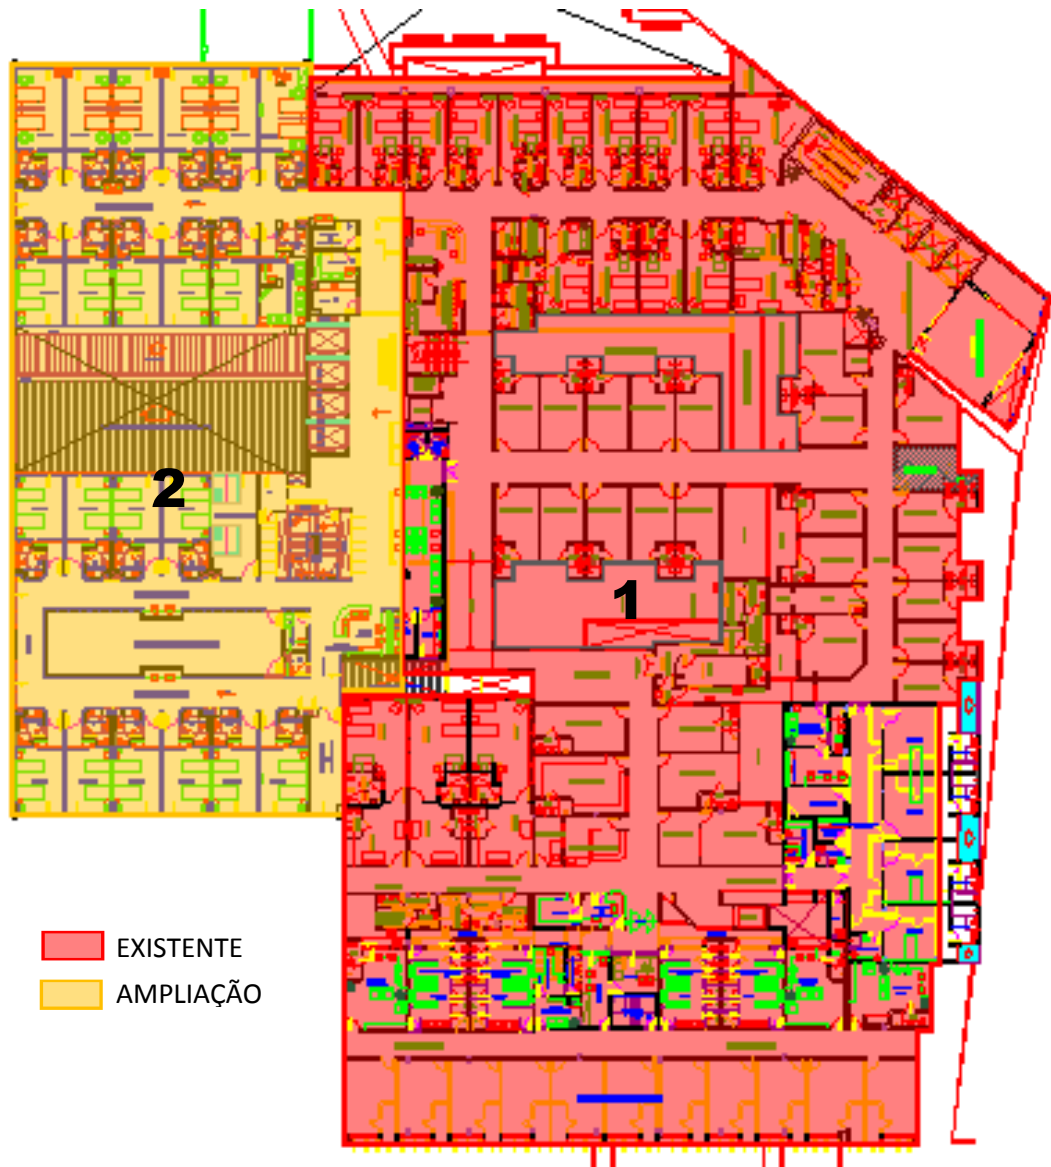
Planta baixa do pavimento tipo, Hospital São Domingos, São Luís, MA. – (1) Setor de Internação e setores de apoio e (2) Ampliação do setor de Internação.
